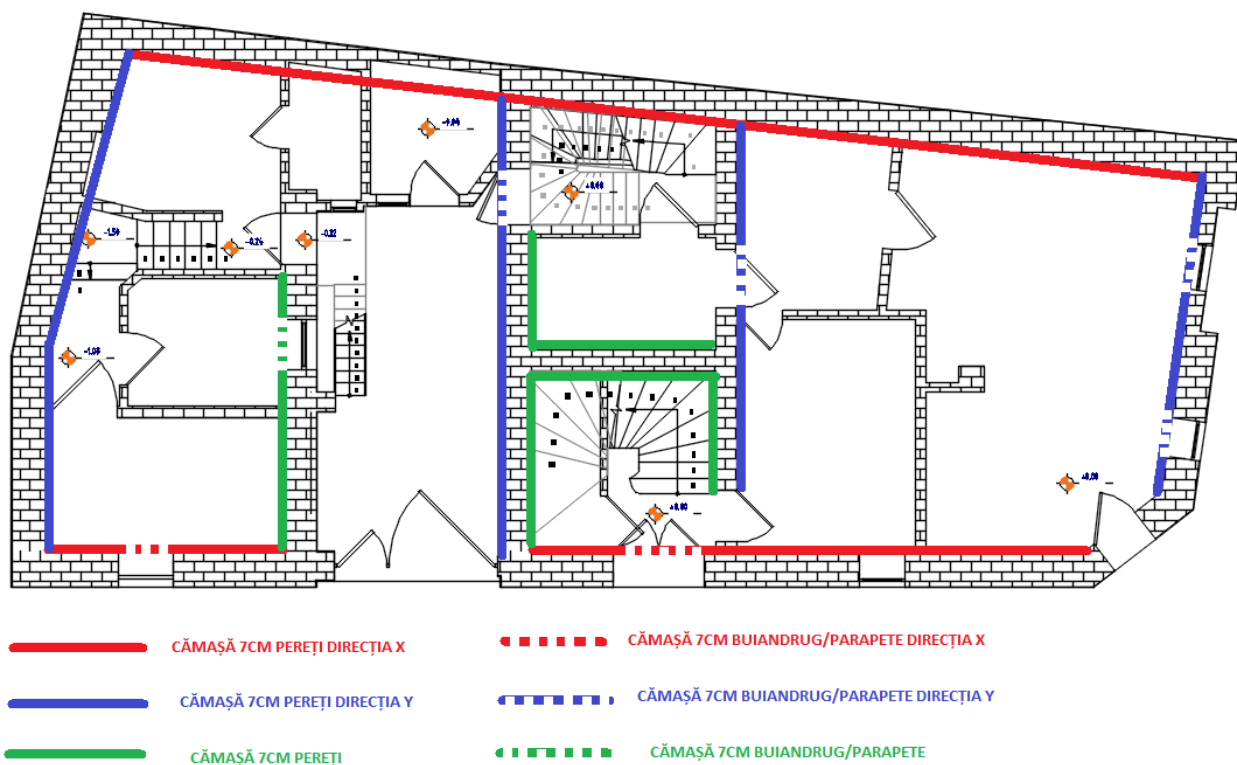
Propunere de consolidare a pereților prin cămășuire la interior cu beton 7cm, Varianta minimală (roșu + albastru) și Varianta Maximală (roșu + albastru + verde)
